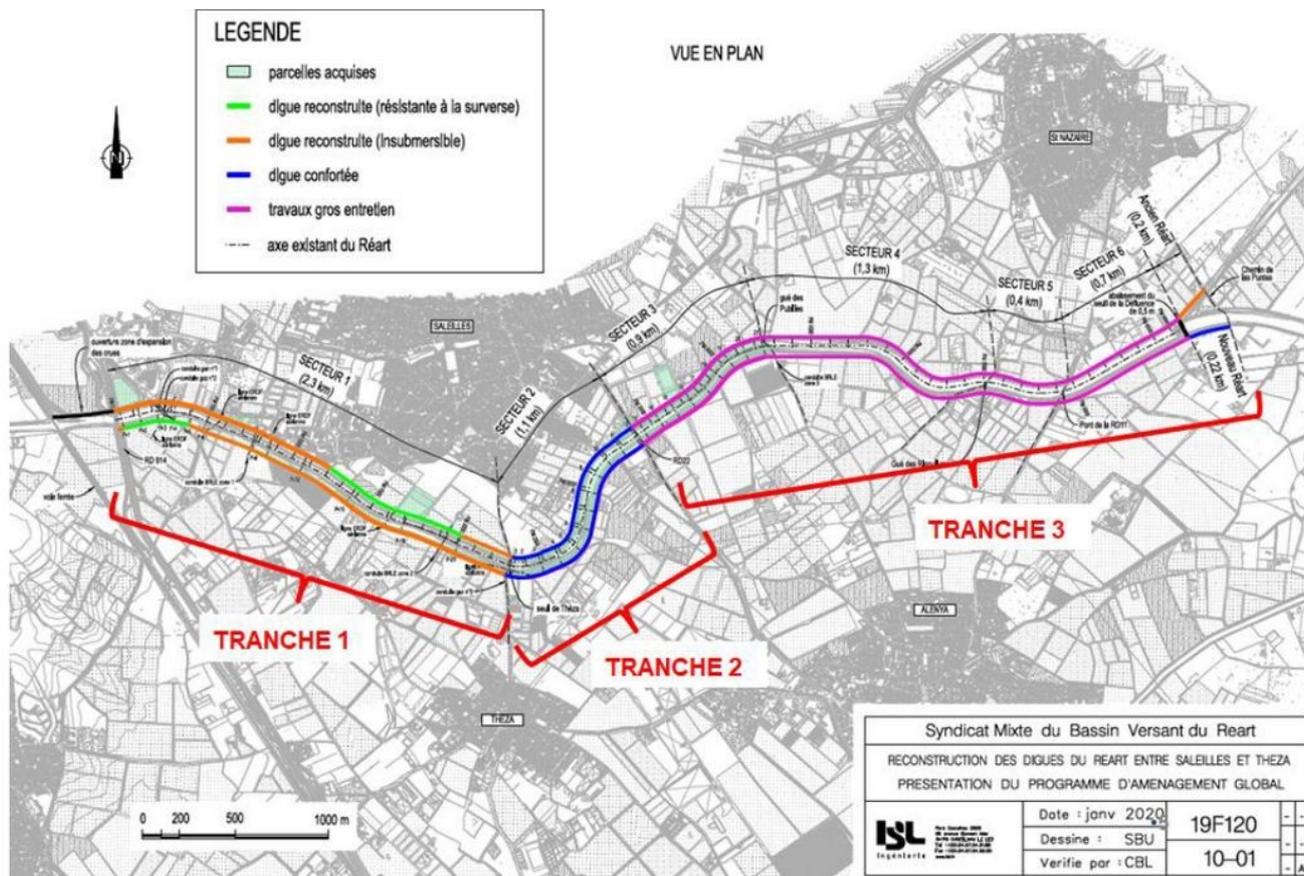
sectorisation du couloir endigué et tranches de travaux
